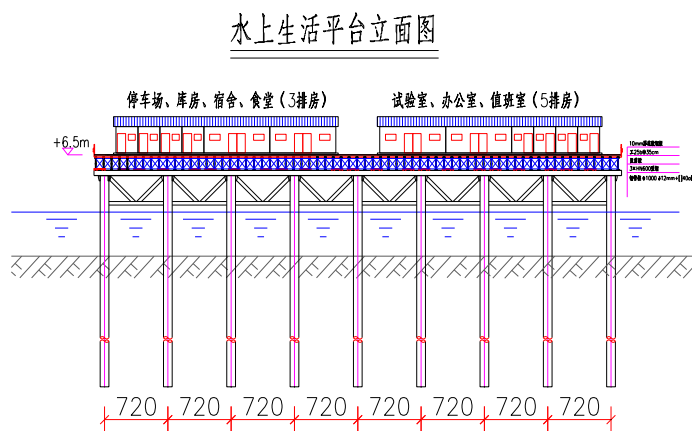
水上生活及办公平台立面图 (单位: m)
